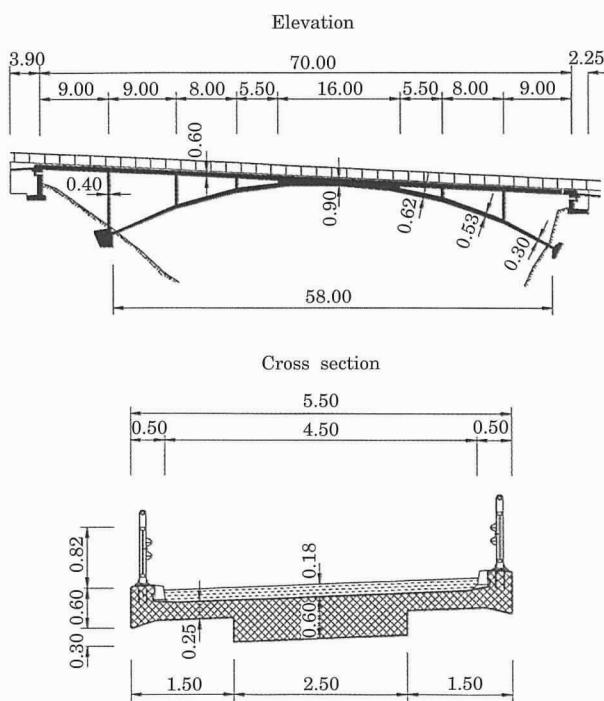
新Valtschiel Bridge の形状寸法 (単位: m)
